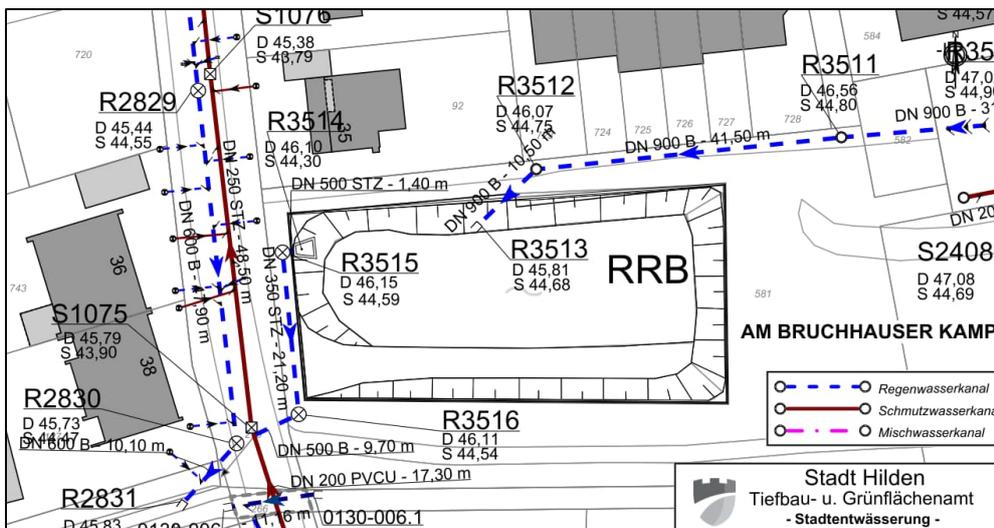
Kanalnetzplan RRB Am Bruchhauser Kamp
